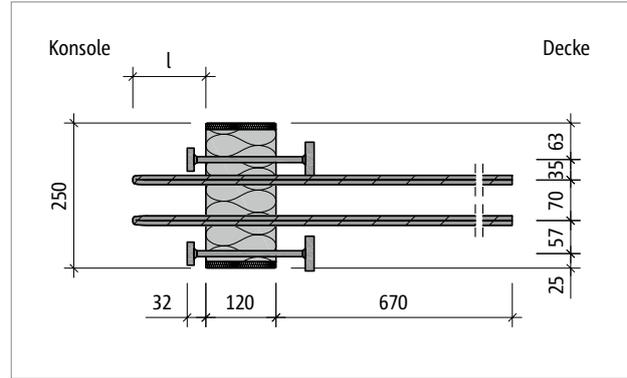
Schöck Isokorb® XT Typ O: Produktgrundriss
